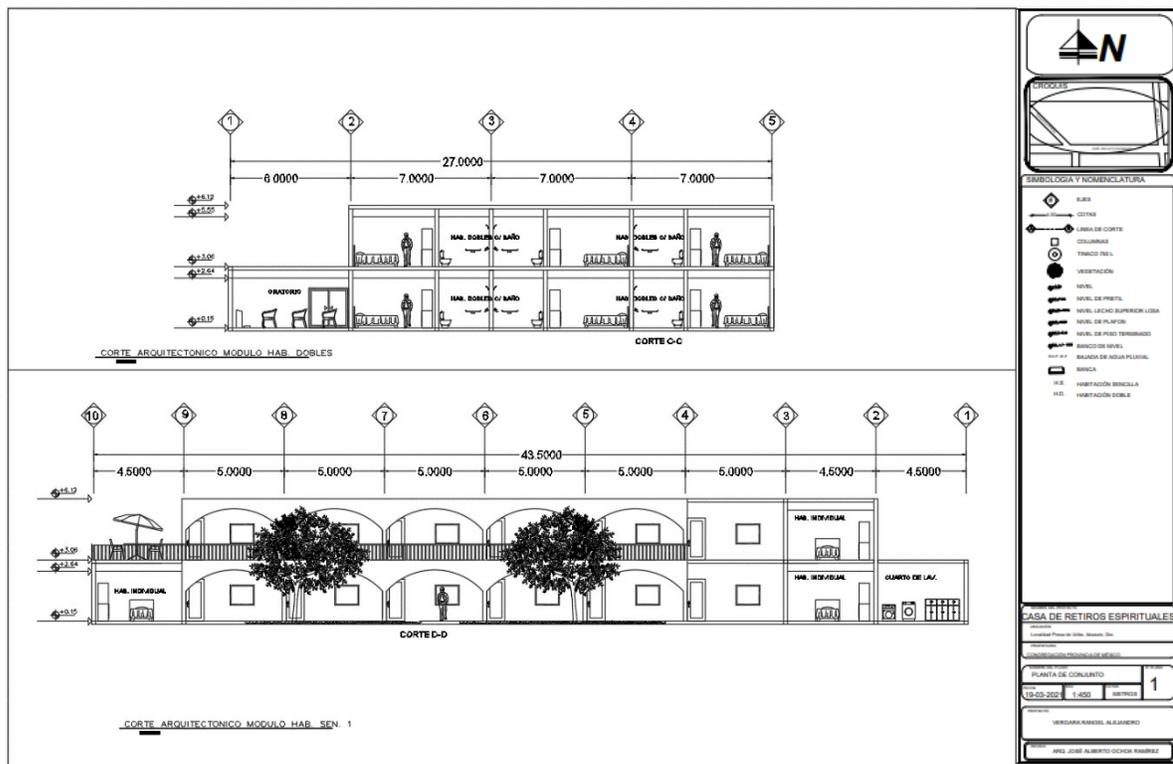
Anteproyecto corte/fachada arquitectónica modulo hab. Sen 1 y dobles (D-D). (Fuente propia, 2021)
